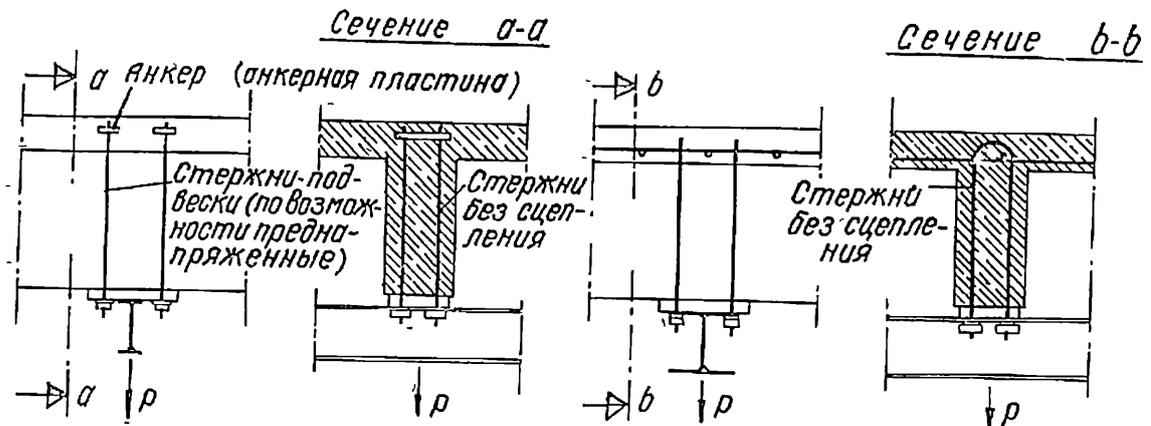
8. Передача на верх конструкции нагрузок, подвешенных снизу, с помощью гладких стержней
